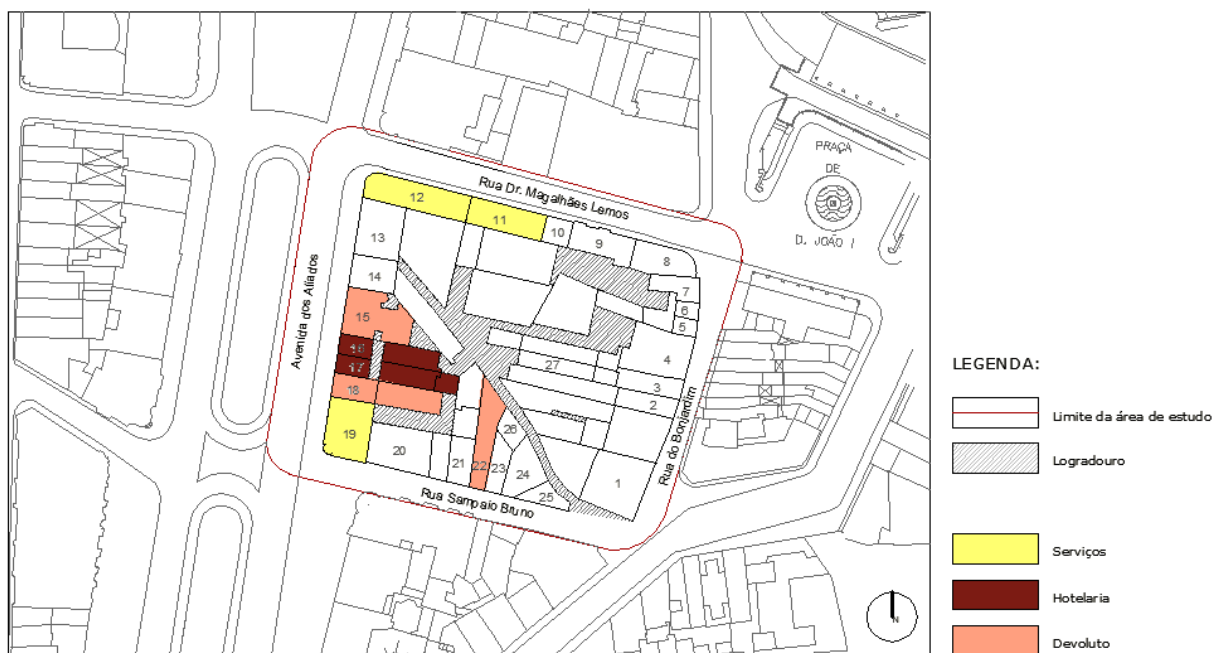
Planta da distribuição de actividades no piso 5. Fonte: Autor.
